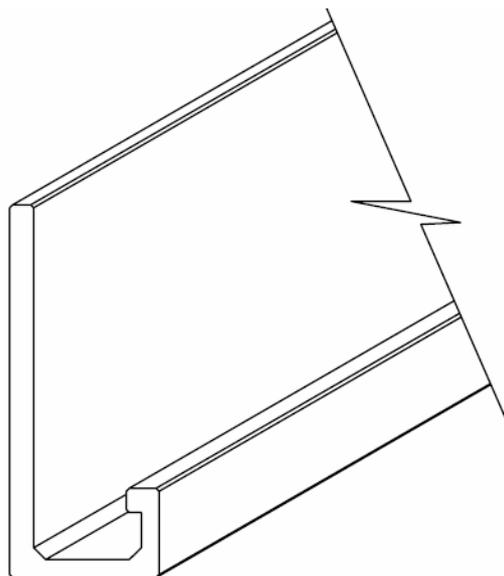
Detalhe da seção da viga calha “J”.
